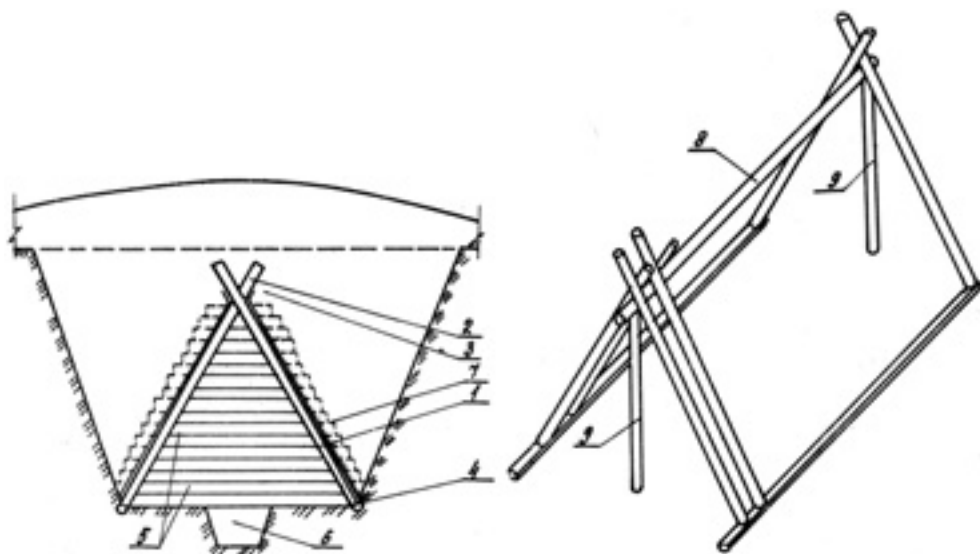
Сооружение податливой конструкции из лесоматериалов: 1 – наклонные опоры из бревен; 2 – опорные части наклонных опор, расположенные в грунте; 3 – насыпной грунт; 4 – продольное бревно; 5 – торцевая обшивка; 6 – прямая; 7 – гидроизоляция; 8 – верхнее продольное бревно; 9 – стойка
